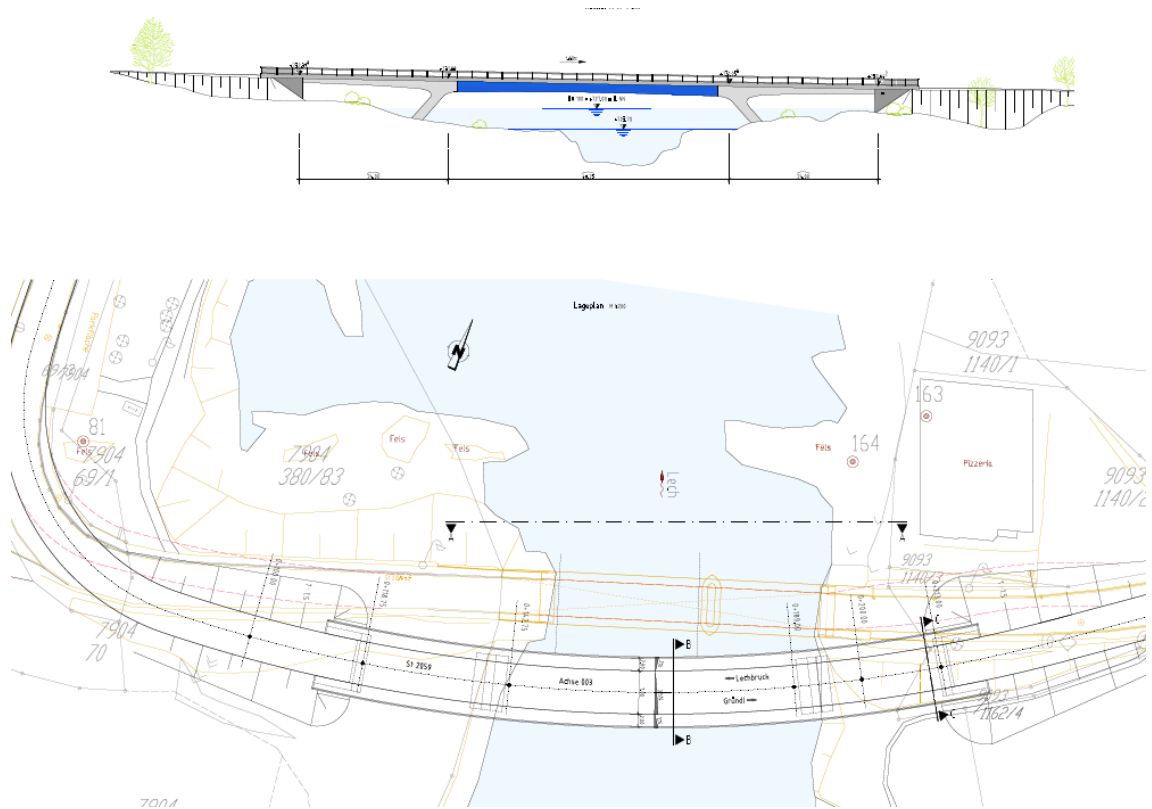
Variante 5 in Grundriss und Ansicht
